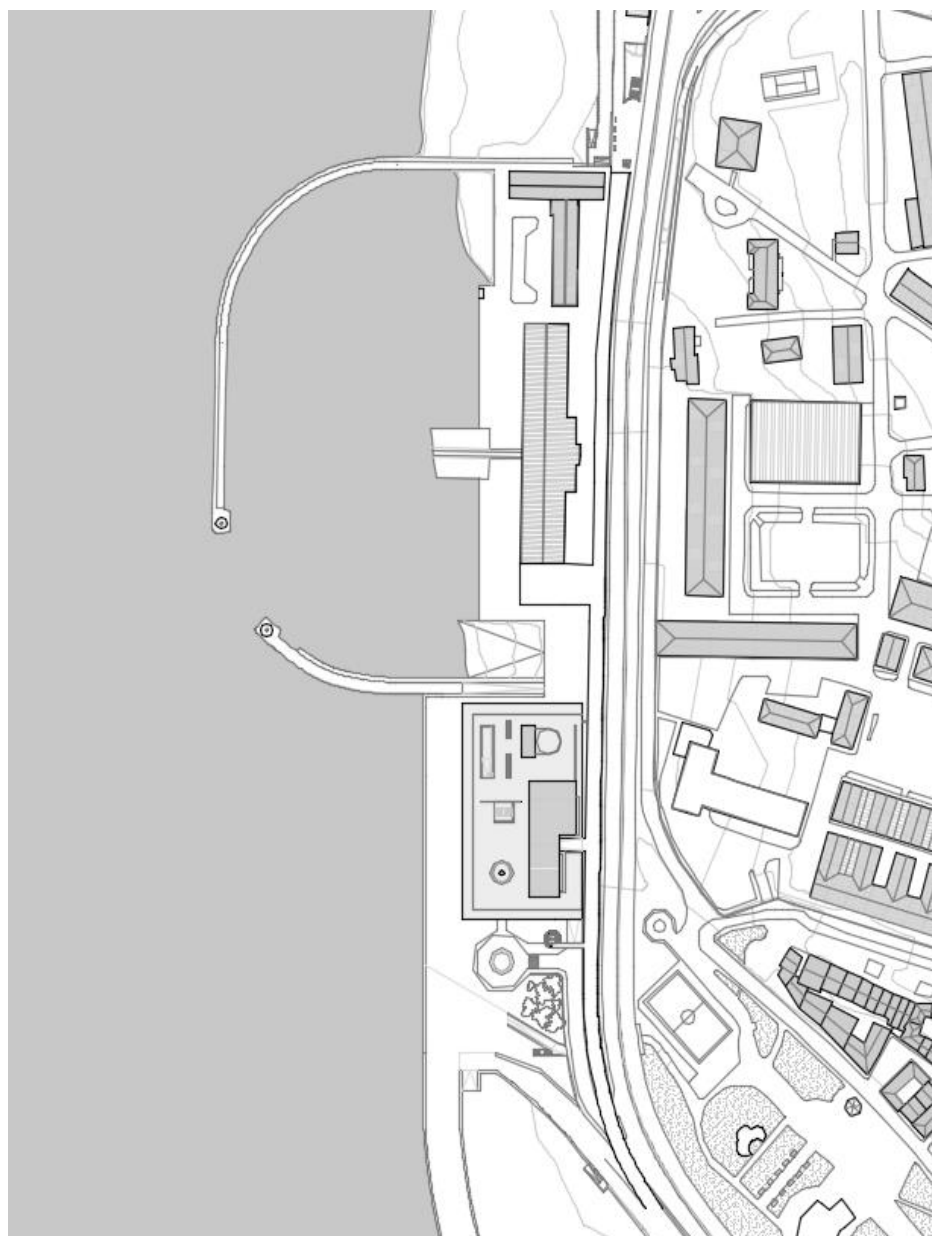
Planta de implantação do Polo de Desenvolvimento Náutico.
